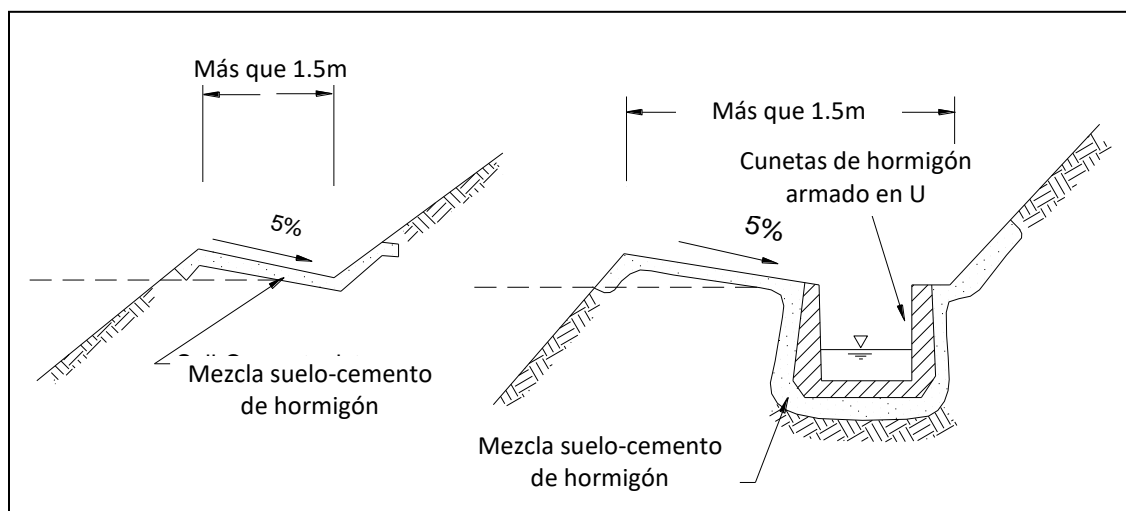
15 Detalles de canal de drenaje de Berma, GENSAI, 2018.
